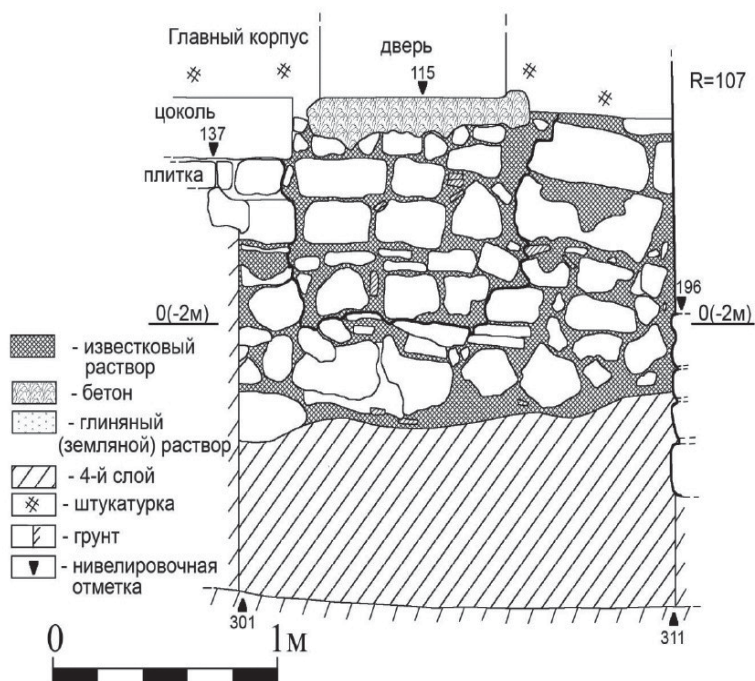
Шурф 5. Фундамент Главного корпуса южная стена
